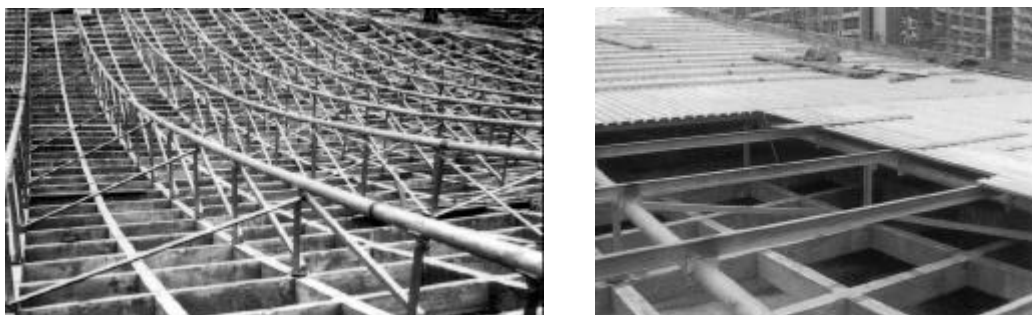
Etapa de montagem do reticulado espacial em concreto armado. fonte : BURO HAPPOLD – Consulting Engineers (Patterns 9).
